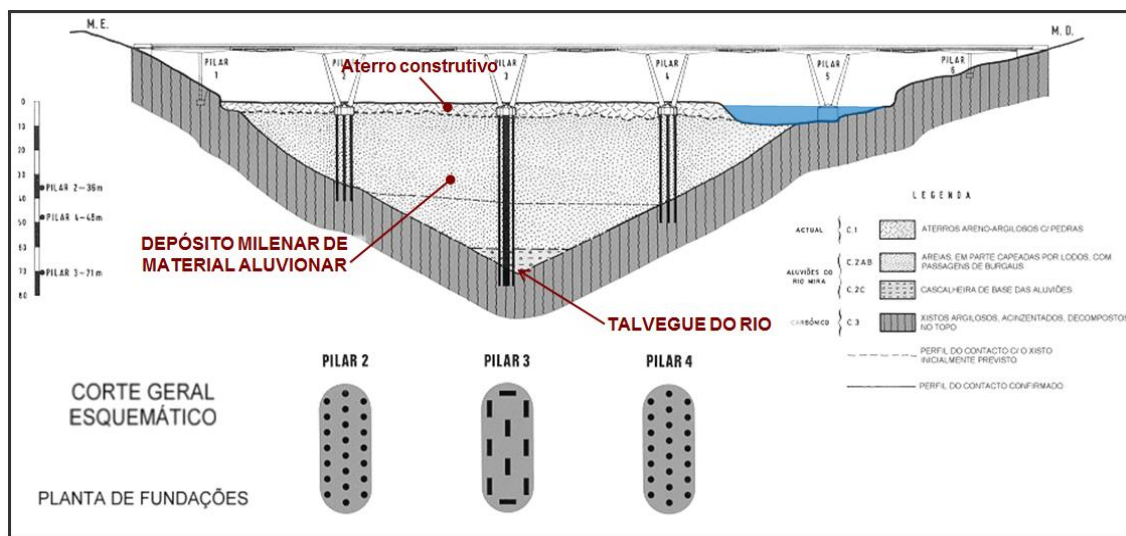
Corte longitudinal já com a correção do perfil geológico interpretativo e a reformulação da solução para as fundações indiretas do pilar P3
